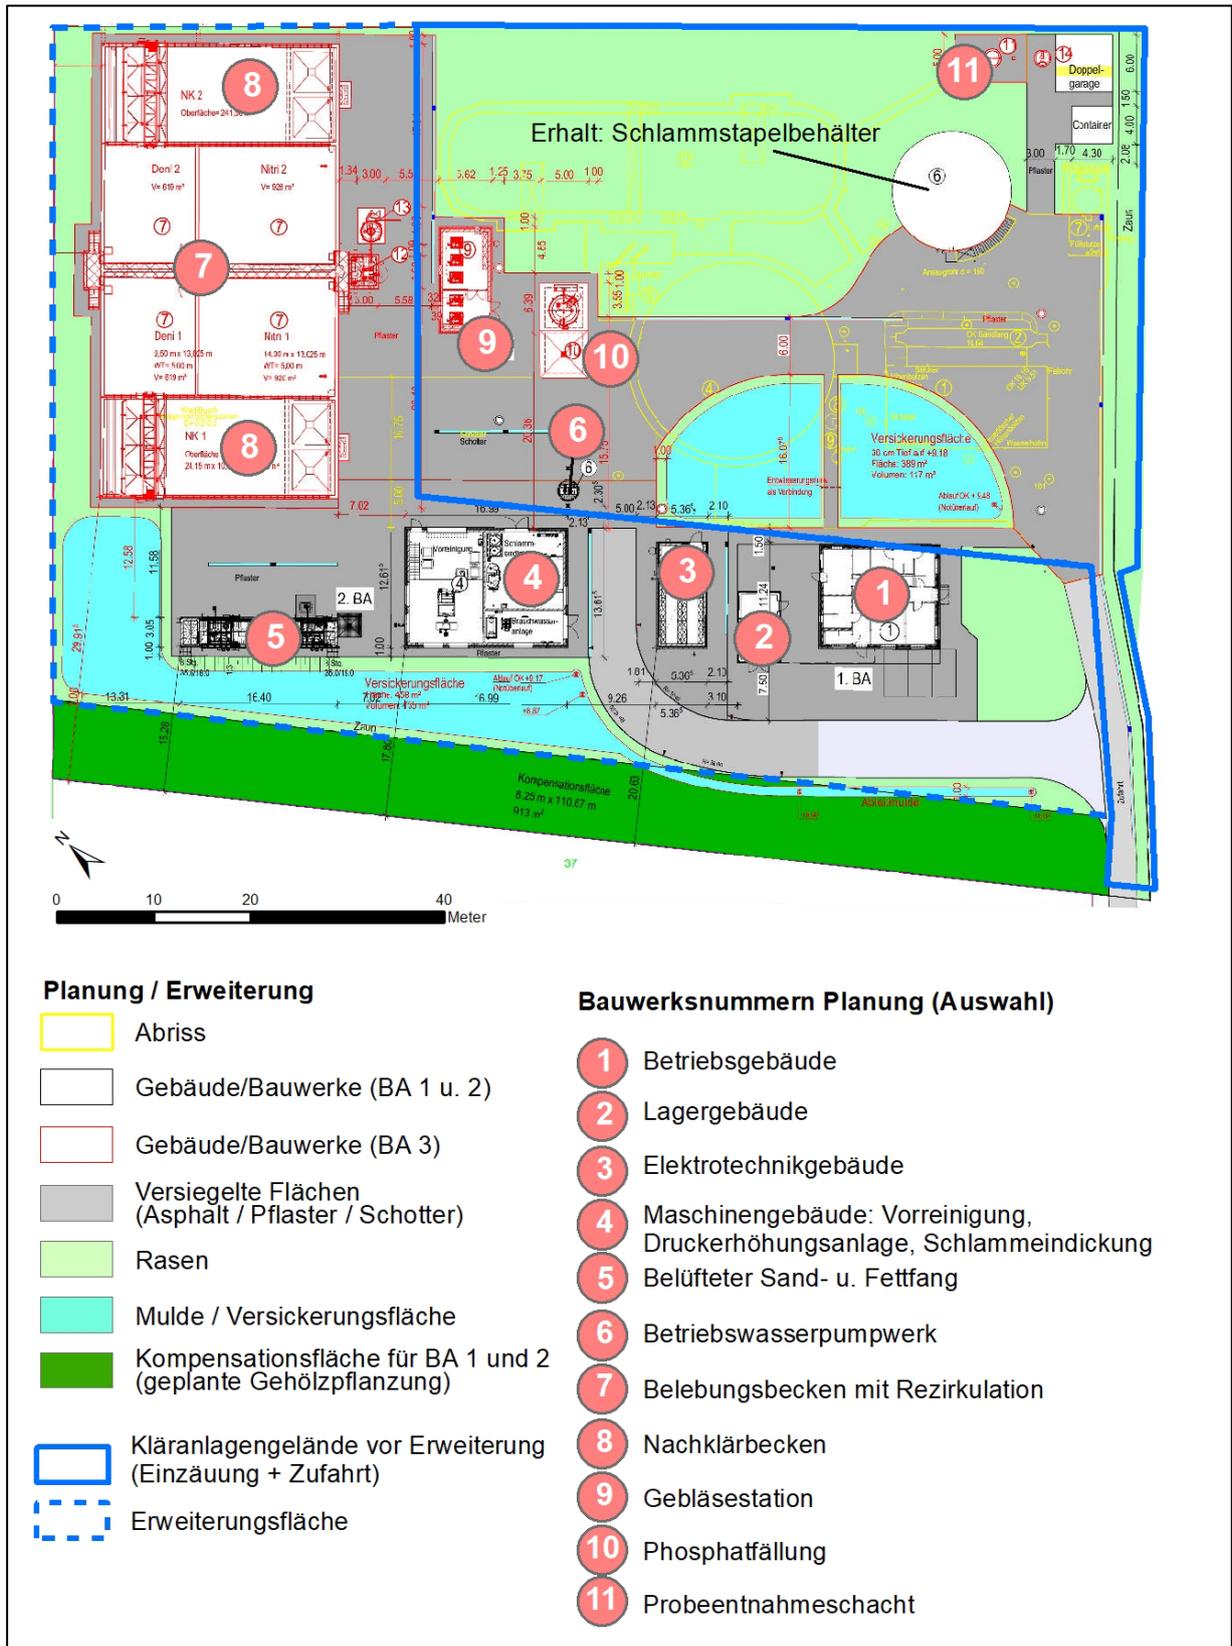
Geplante Erweiterung der Kläranlage (Auszug aus Lageplan, verändert)
